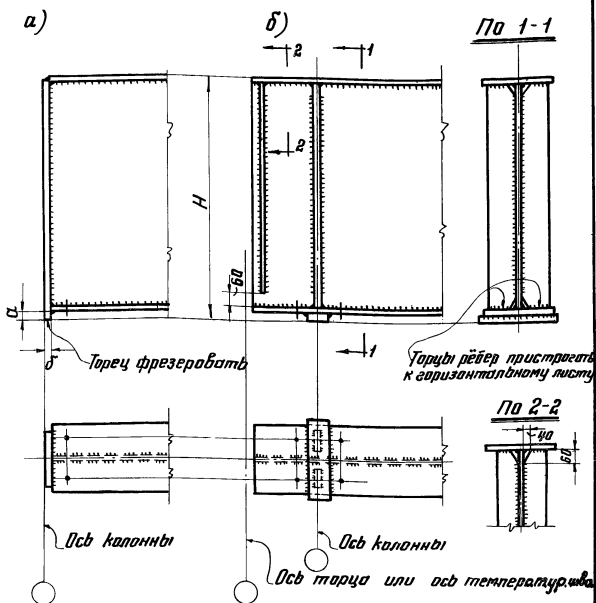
Опорные части разрезных сварных подкрановых балок:
